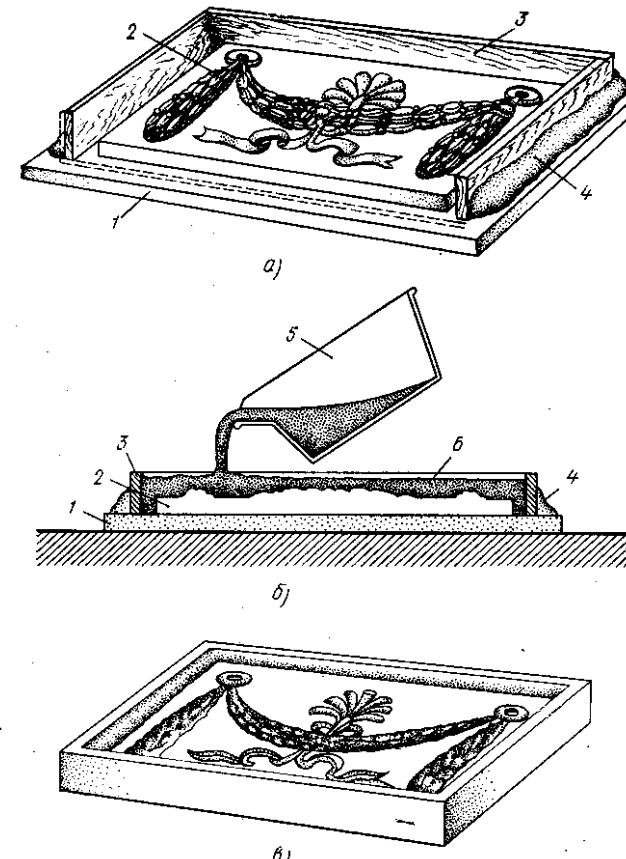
Изготовление открытой kleевой формы с плоской модели низкого рельефа:
